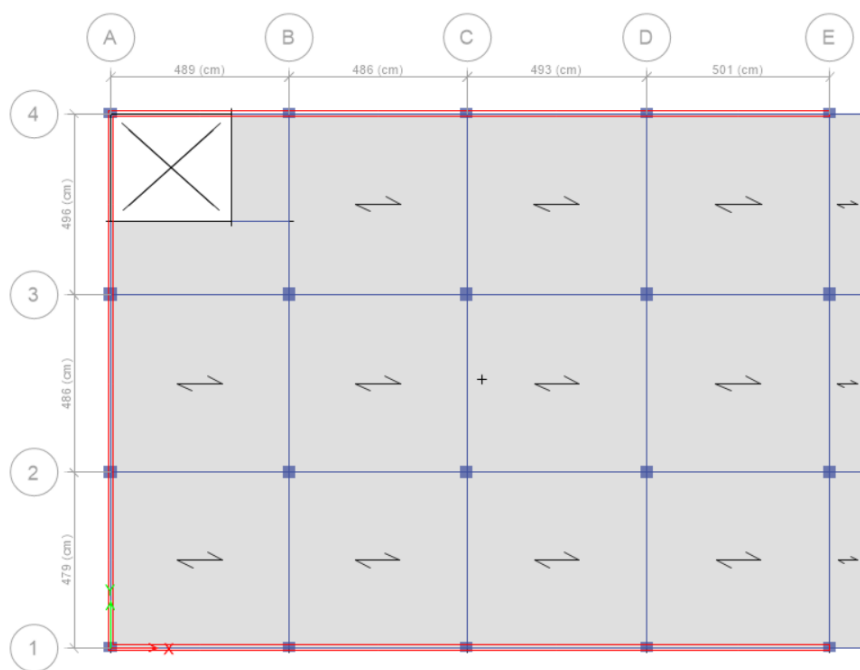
Distribución en elementos estructurales - Nivel 04 y 05
